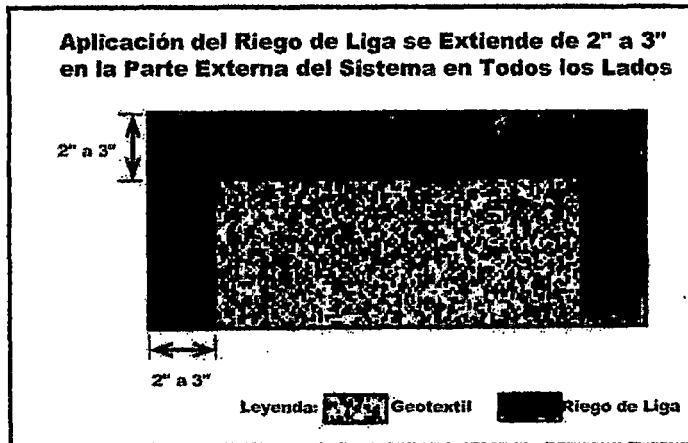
APLICACIÓN DEL RIEGO DE LIGA
